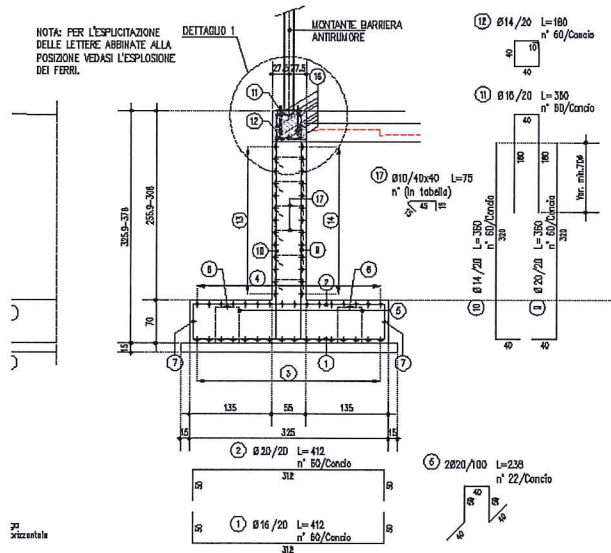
Schema armatura – Muro tipo 1 –Conci 1-5
